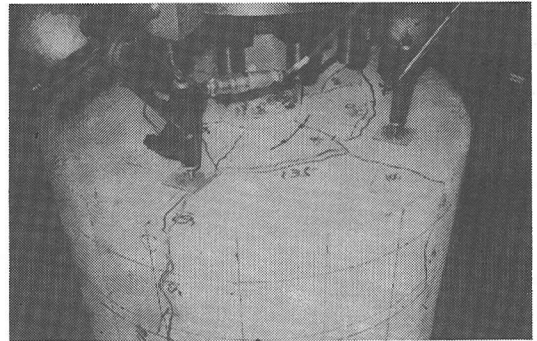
躯体上面および側面でのひび割れ状況 (STP-2)
